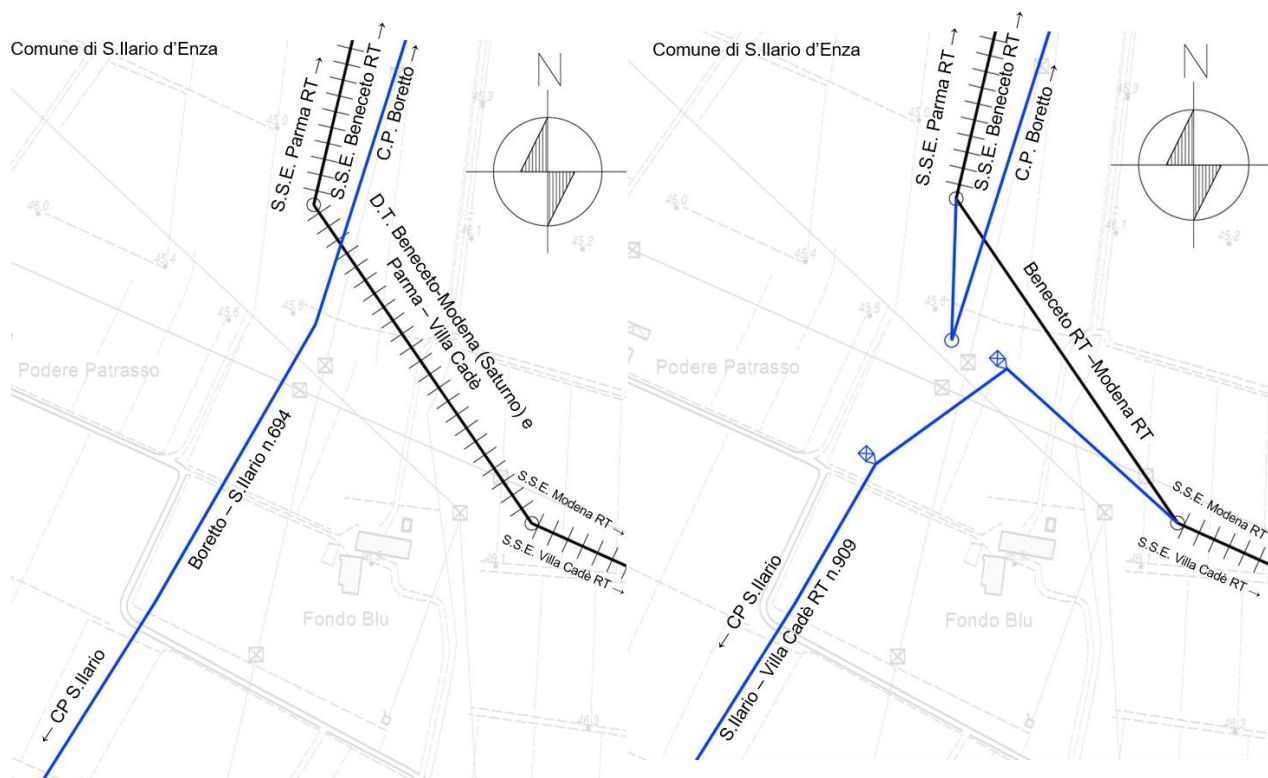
Stato attuale (sx) e futuro (dx) dell'intervento SI2
